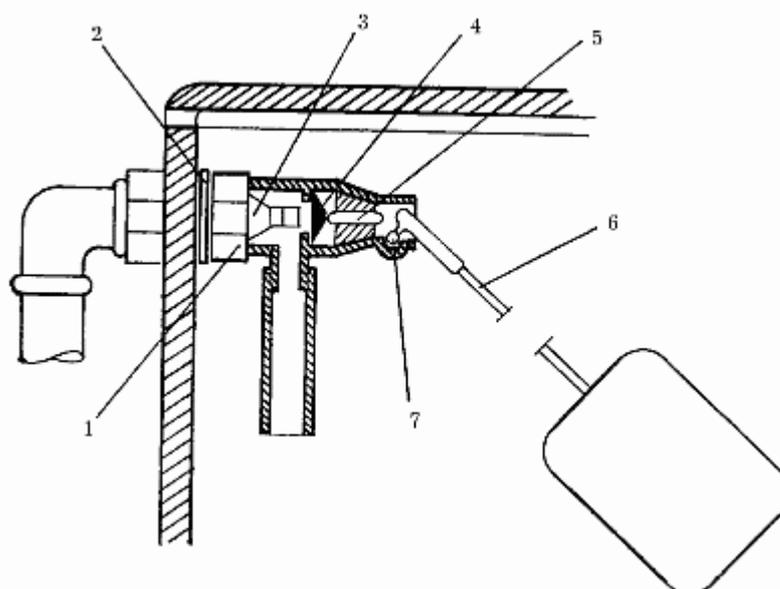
Устройство поплавкового клапана: 1 – прижимная шайба; 2 – прокладка; 3 – седло; 4 – мембрана; 5 – стержень; 6 – рычаг поплавка; 7 – ось рычага.
